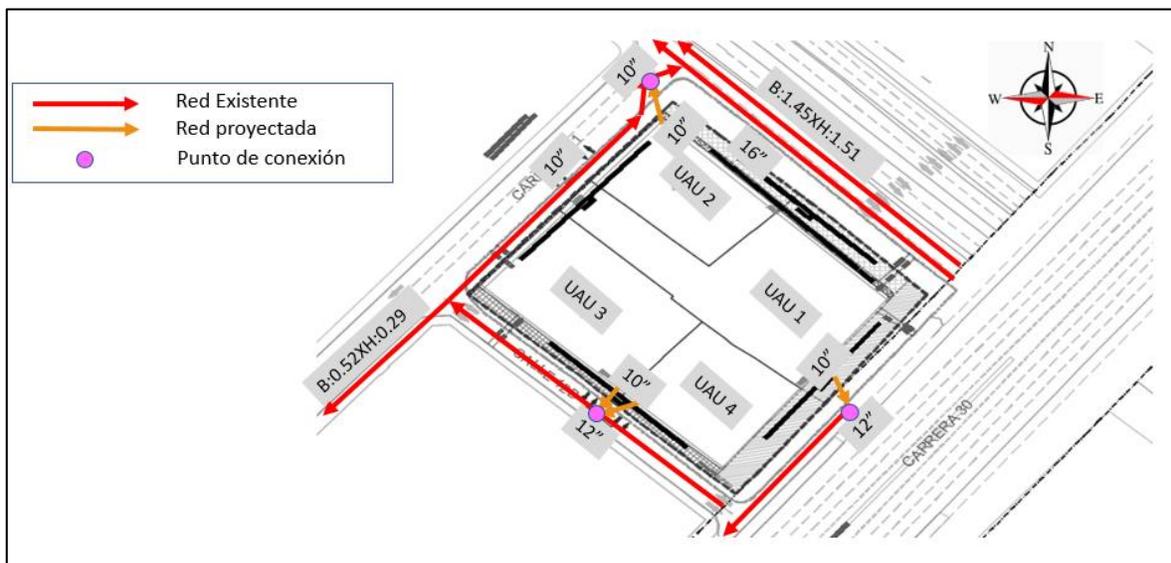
Puntos de conexión Sistema de Alcantarillado Sanitario.
